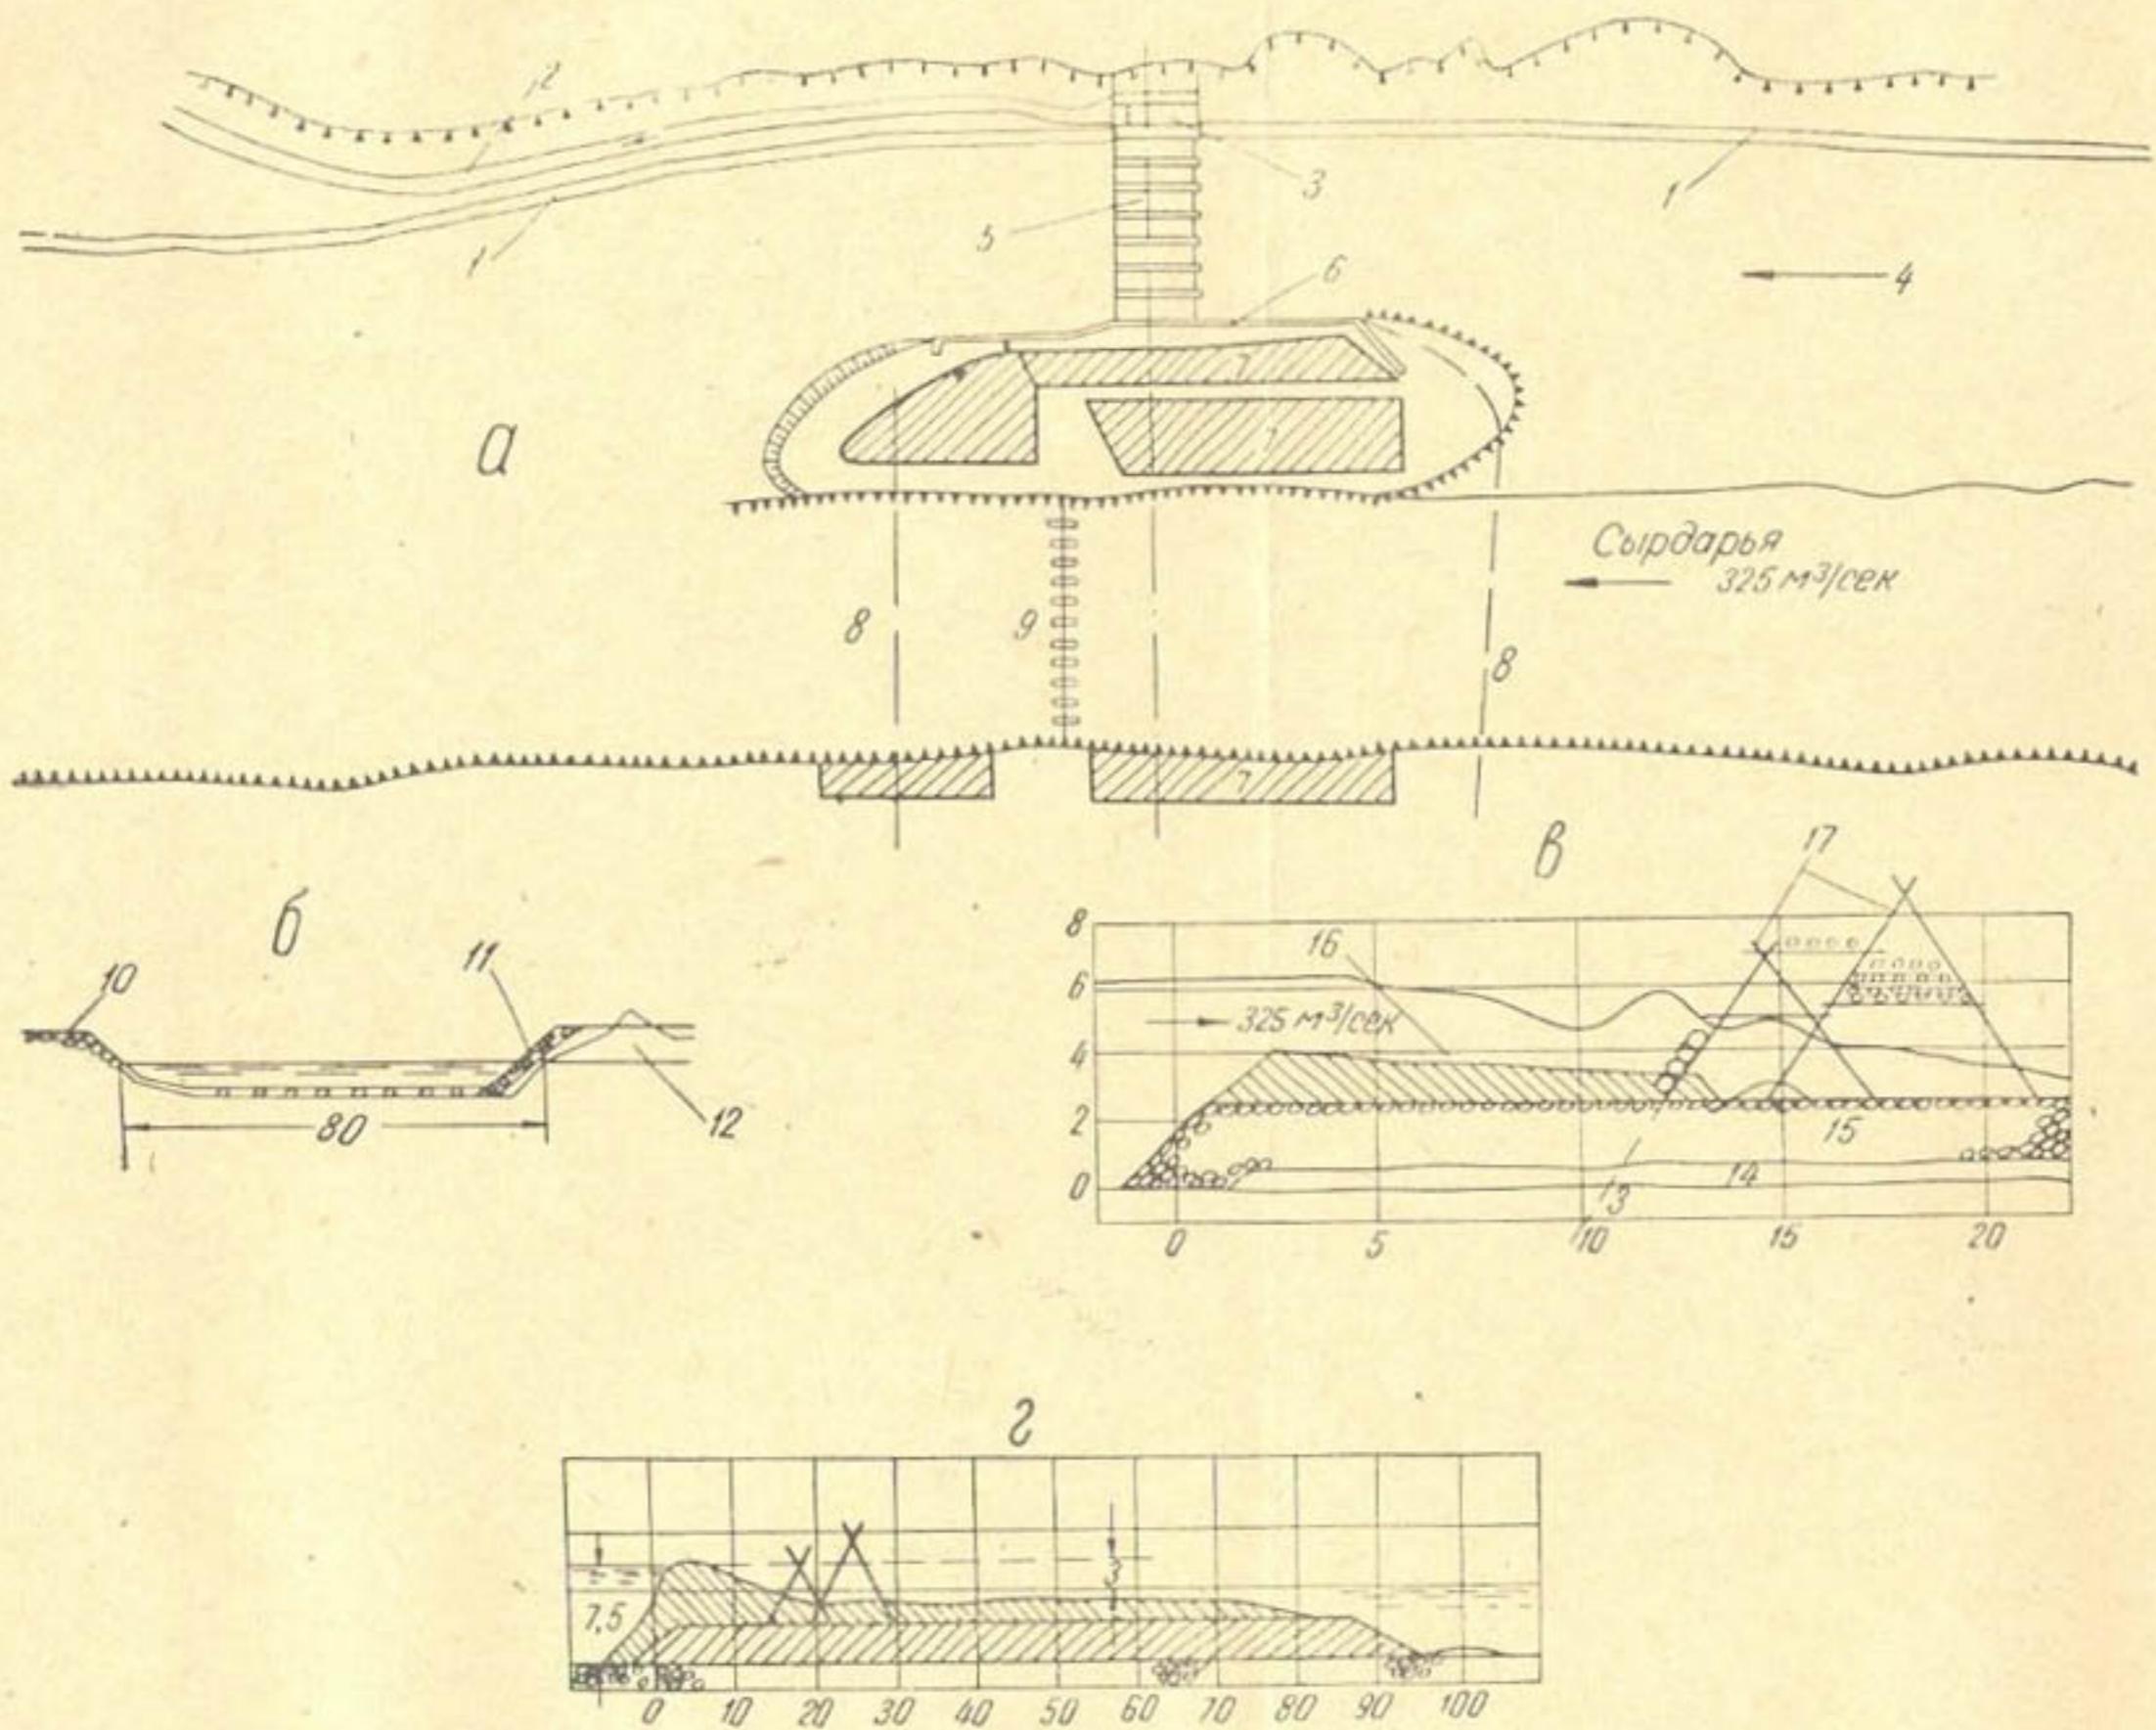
Перекрытие Сырдарьи на Фархадстрое:
